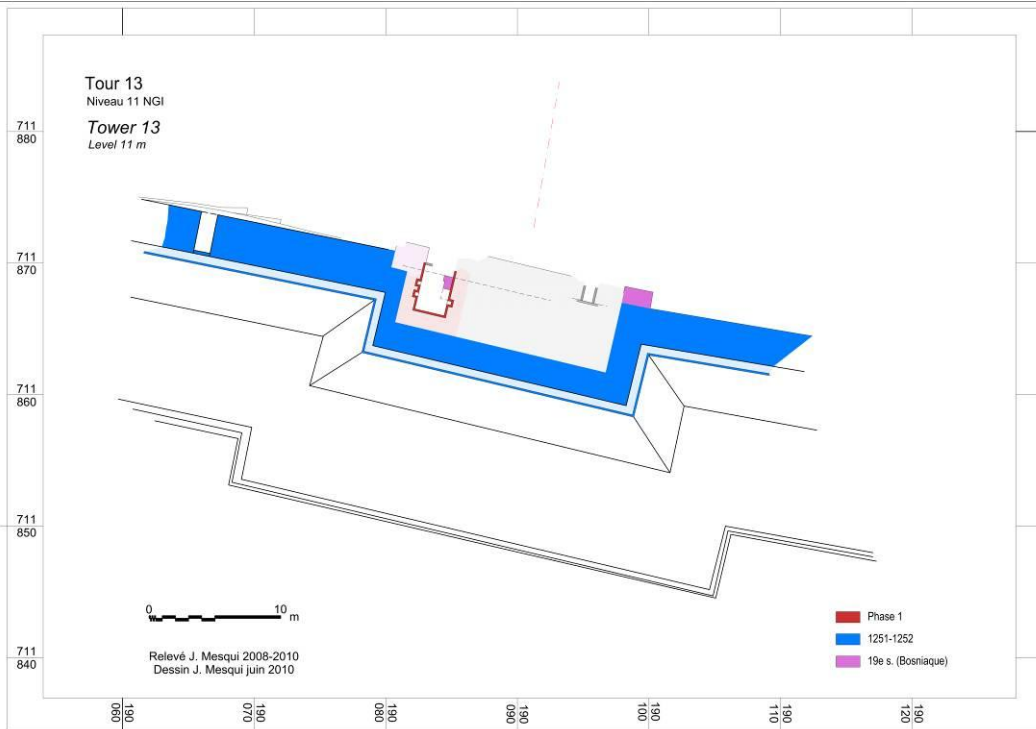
Plan de la tour T13 au niveau 11 m ASL
